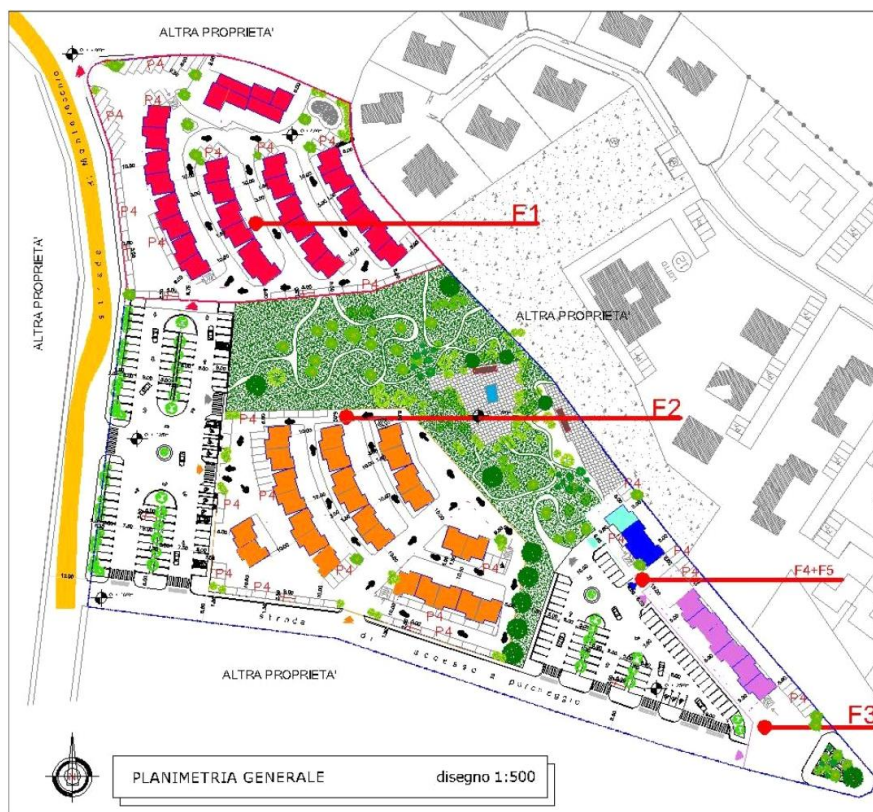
Stralcio della Tavola n. A6 – Planimetria generale
